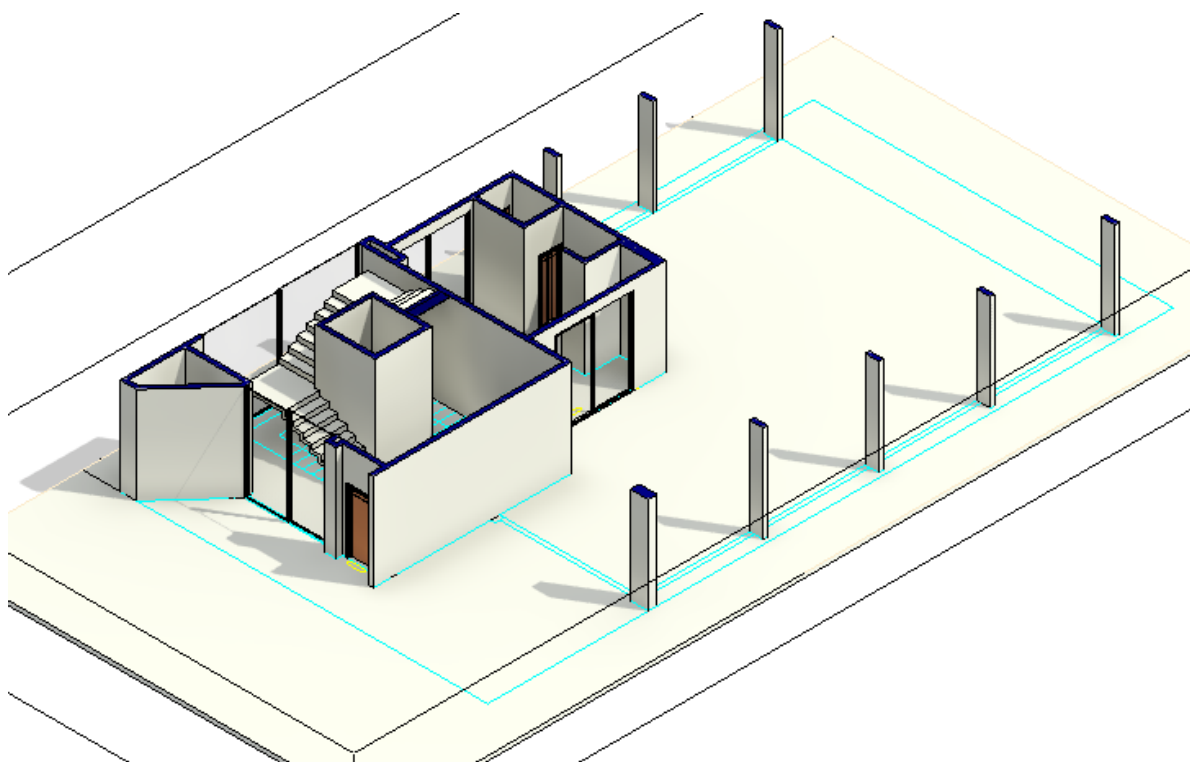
Modelagem Arquitetônica pavimento Térreo, software Revit. Fonte: Autor.
